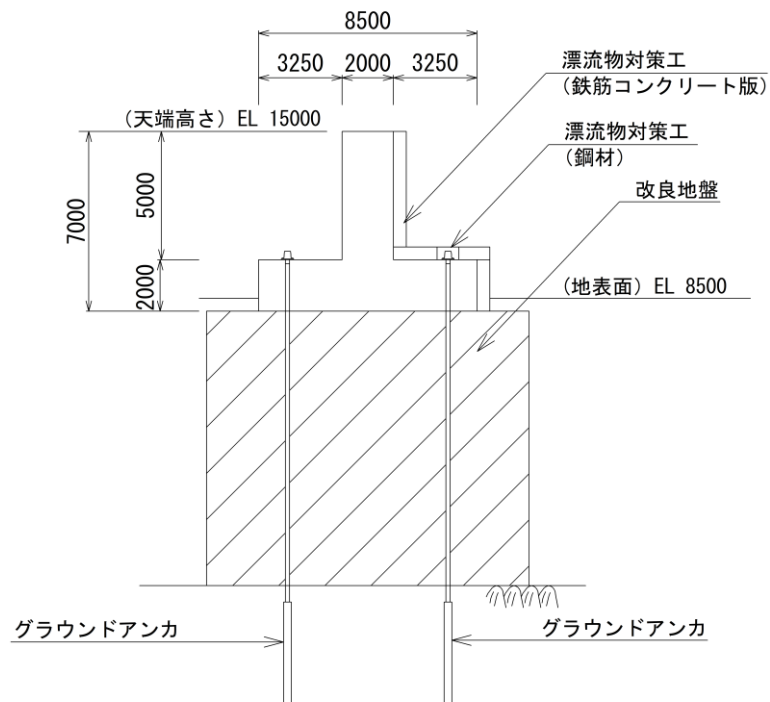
(2) 防波壁（逆 T 擁壁）の構造図（断面図）
